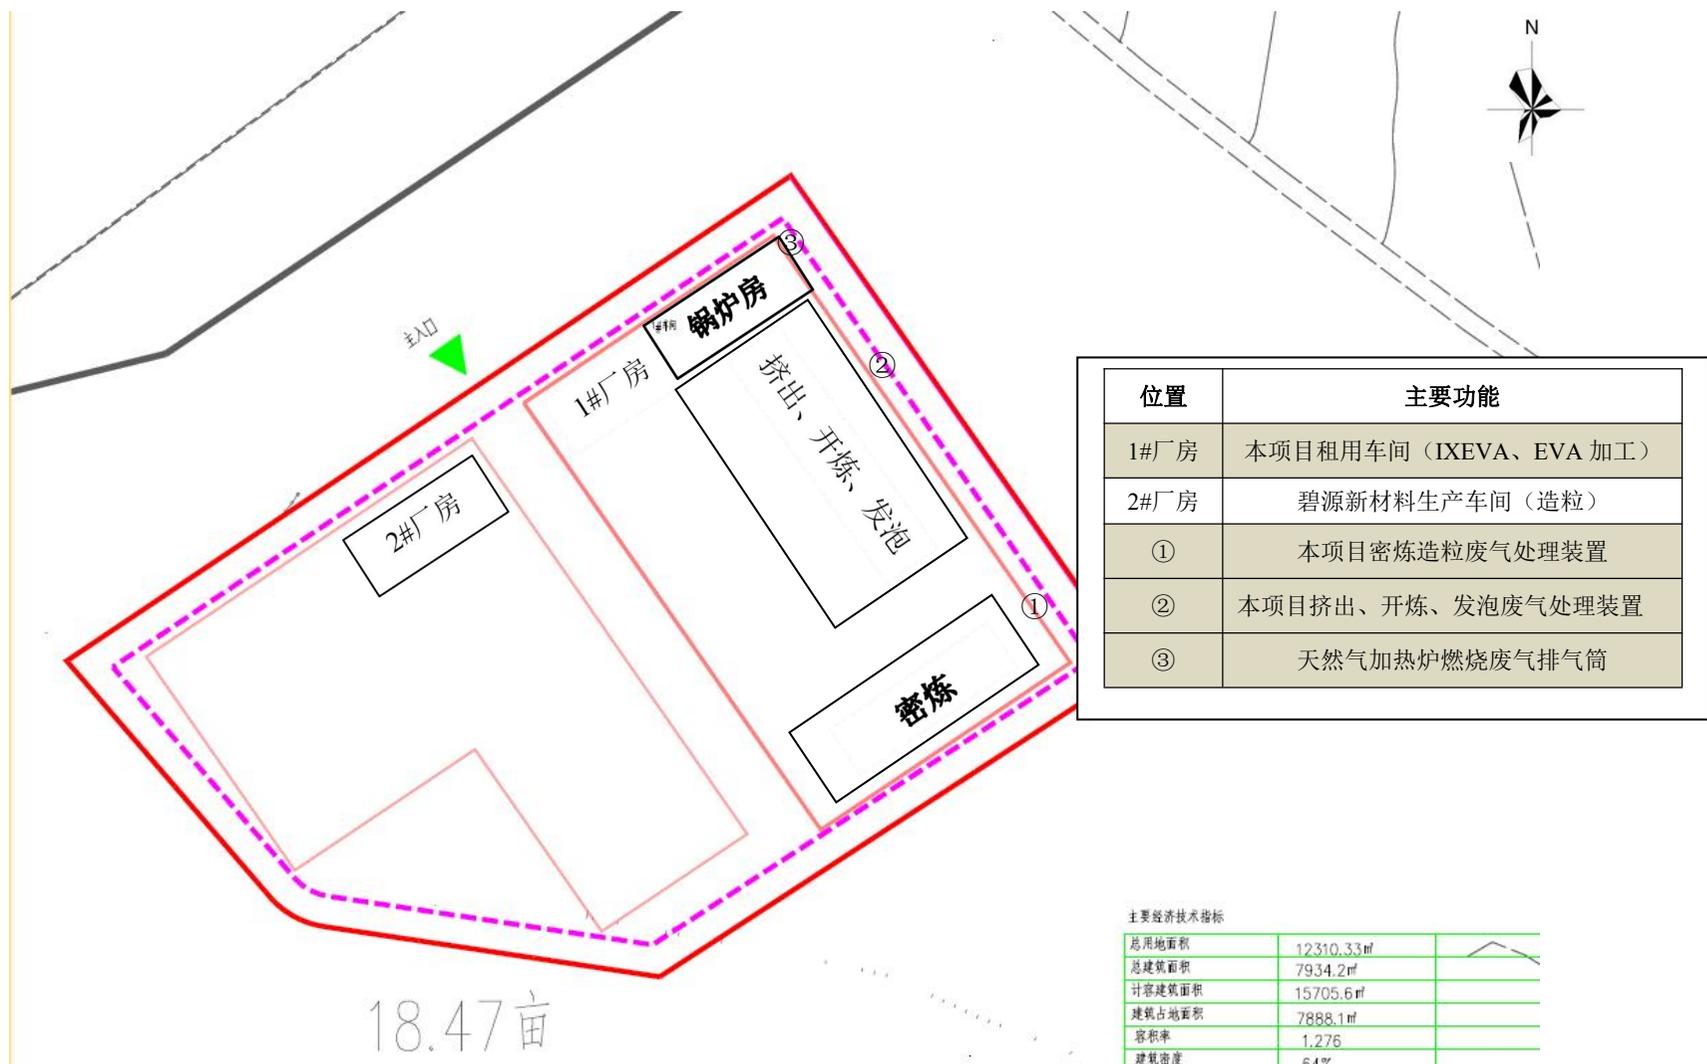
实际厂区平面布置图 (碧源厂区)
